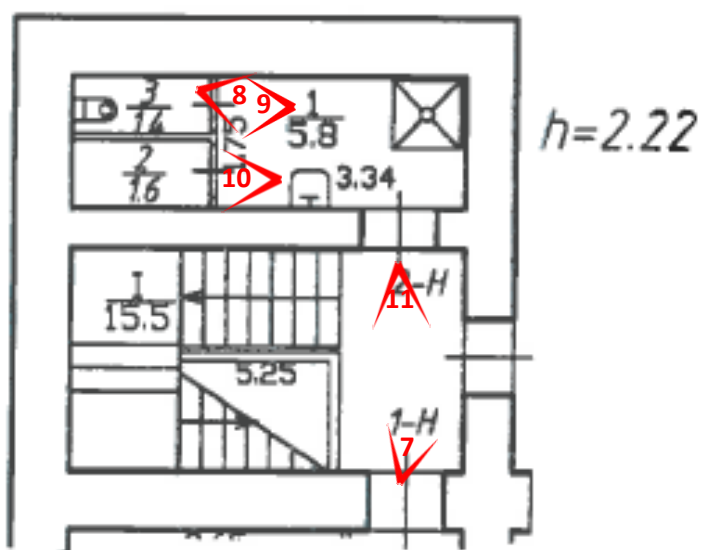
Схема фотофиксации на фрагменте плана 1 этажа (пом. 2-Н)
